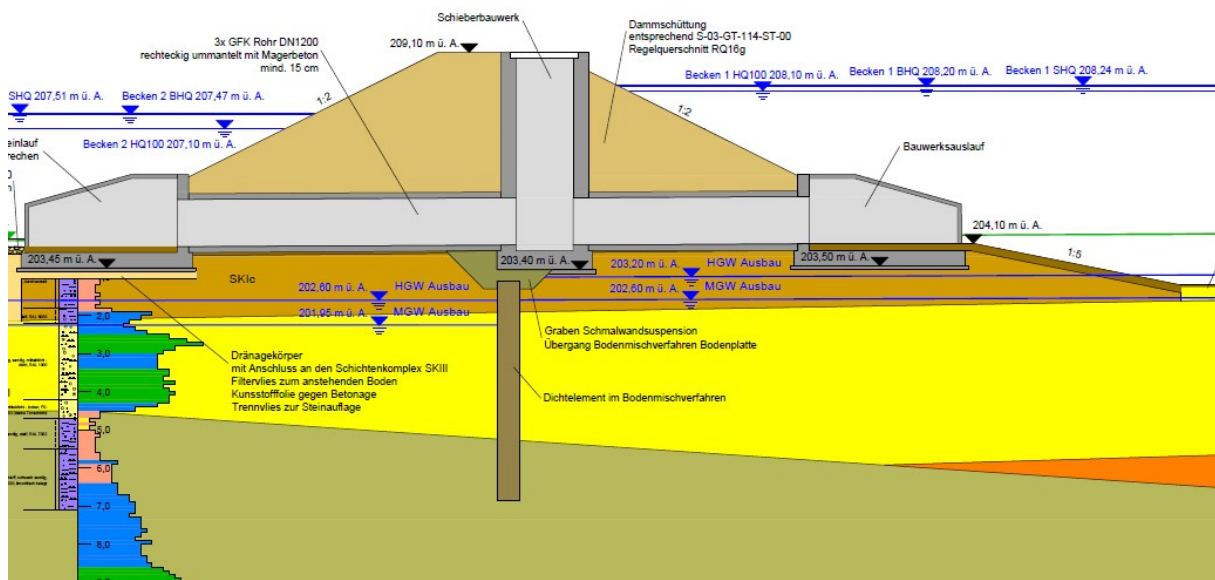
Schnitt durch des Trennbauwerk mit Untergrundverhältnissen ([20], Beil. 3)
